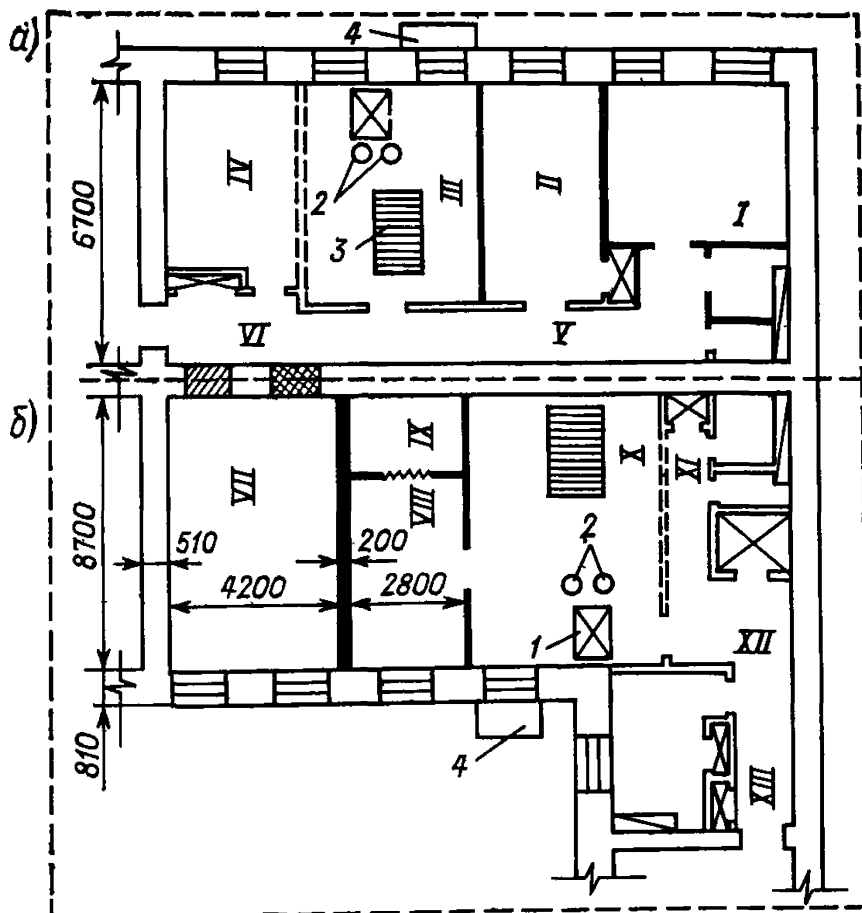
Общая схема организации работ по устройству перегородок из гипсовых плит
